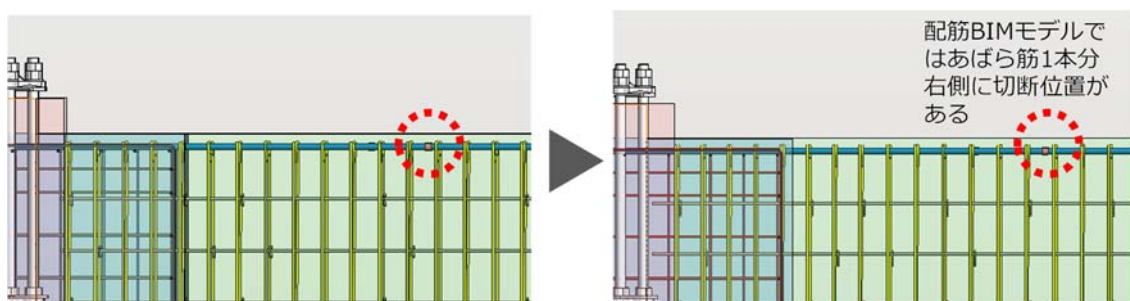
梁主筋の切断位置（左が鉄筋 BIM モデル，右が配筋 BIM モデル）
